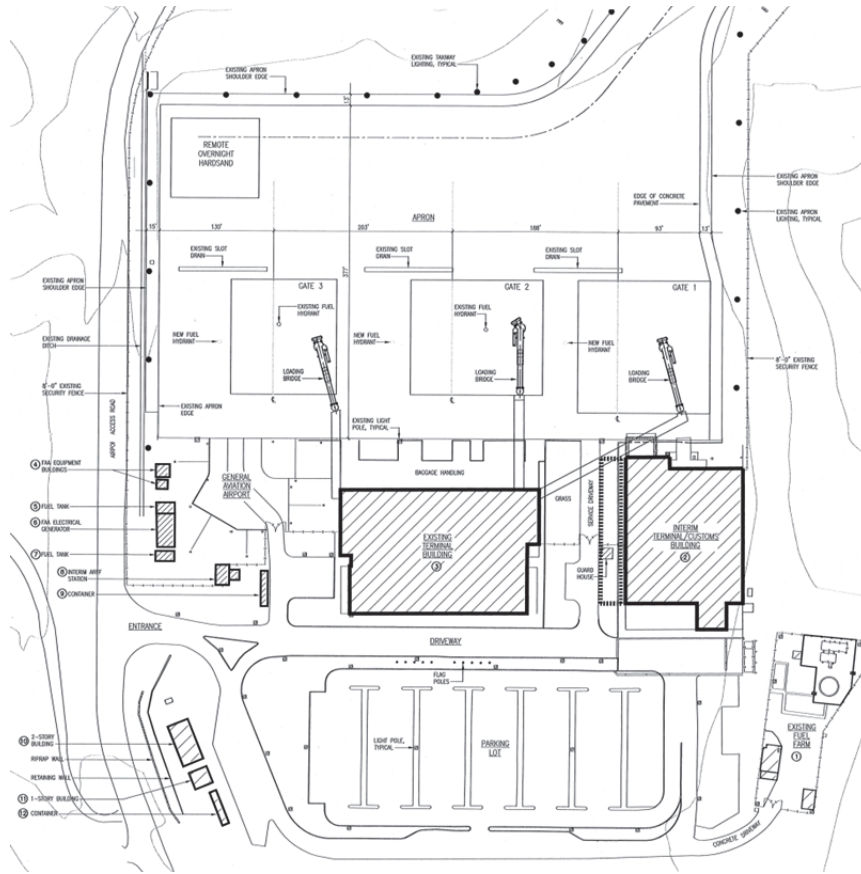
パラオ国際空港南エプロン施設配置図
